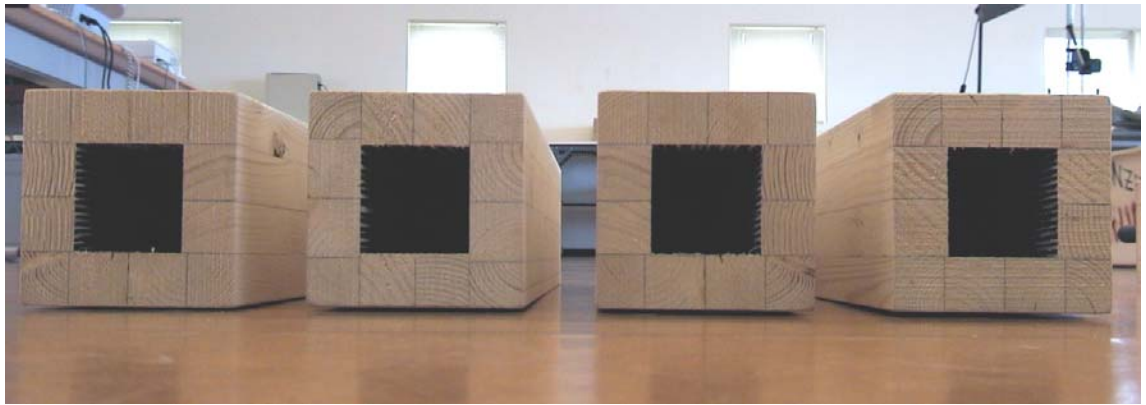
Detalle de la sección hueca de las piezas de madera
